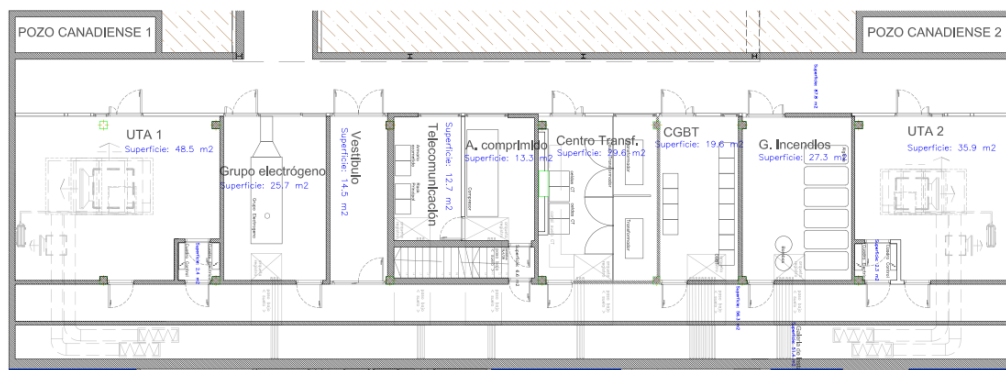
Planta Centro de instalaciones [Elaboración propia]
